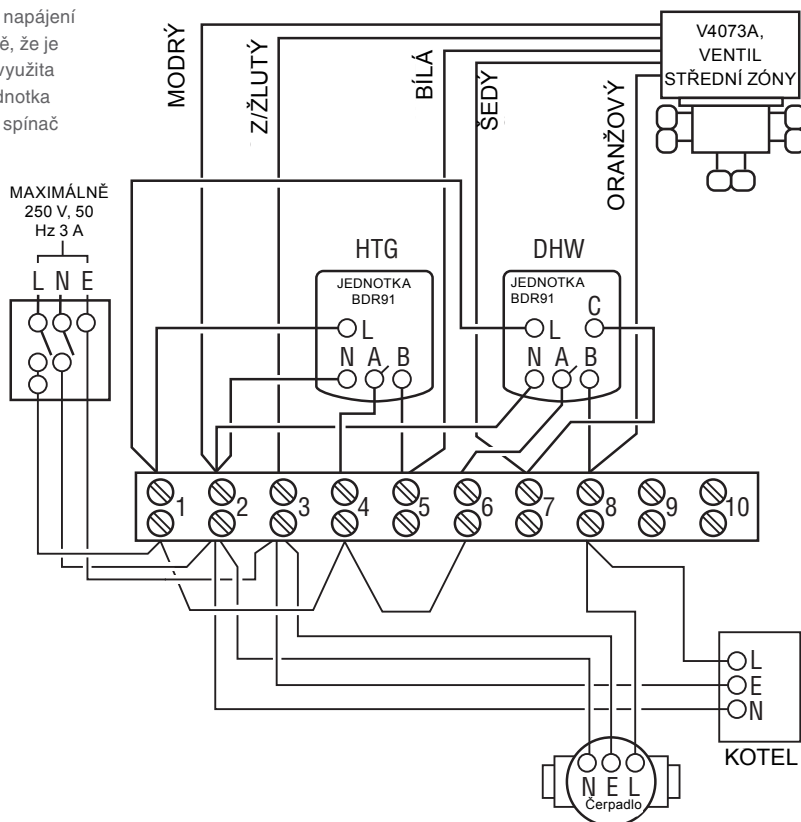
Zapojení rozdělovacího ventilu a kotle
